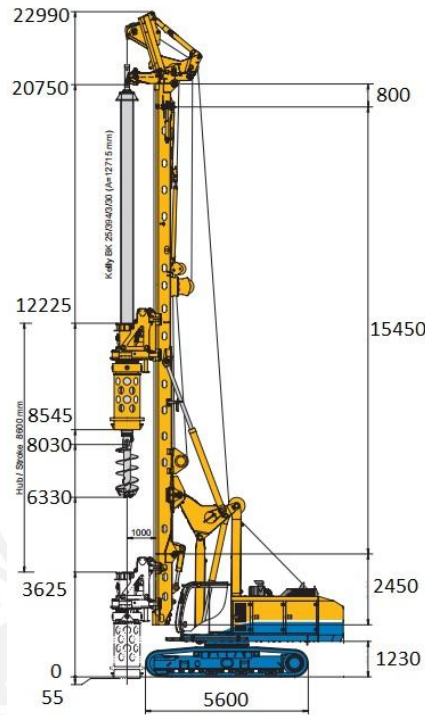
Equipo Bauer BG-22 Pedro (BAUER, 2009)
